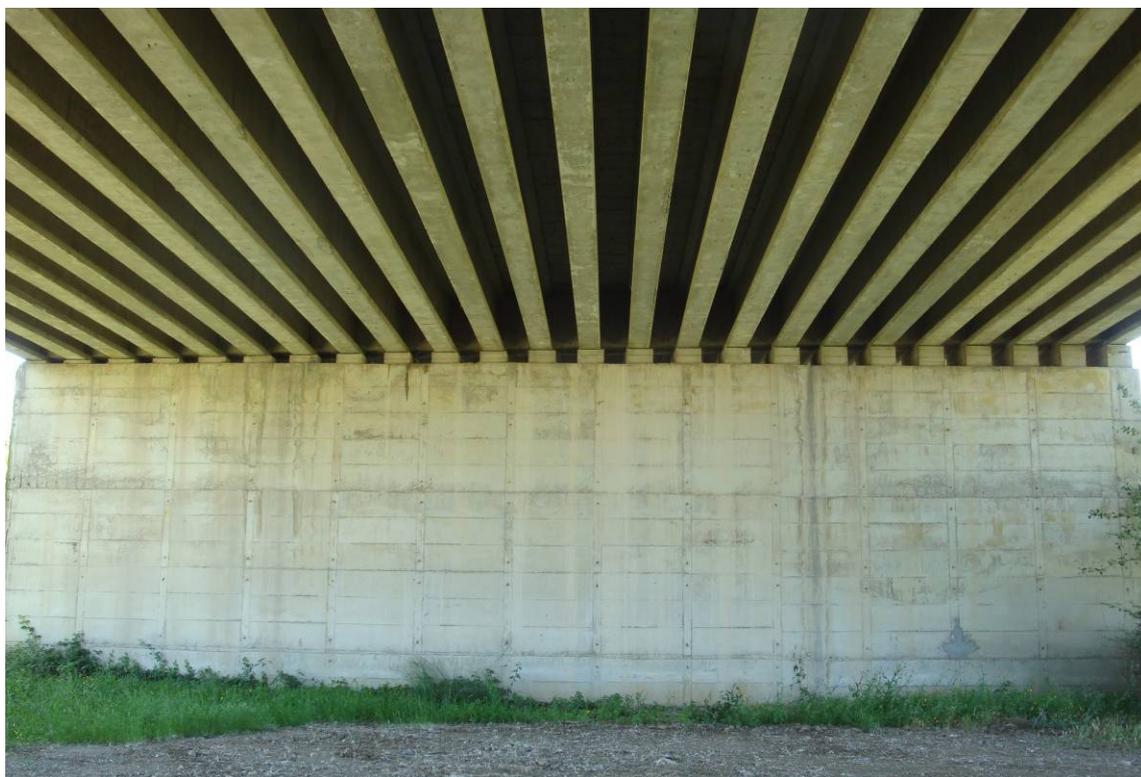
Intradosso dell'impalcato 2 e della pila 1
